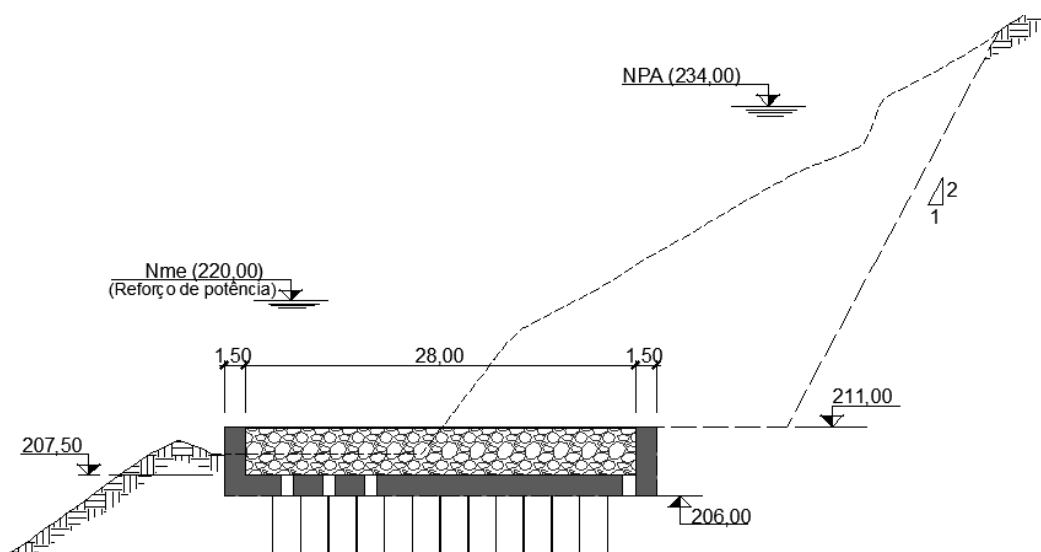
6 - Geometria da base de fundação em corte [29]
